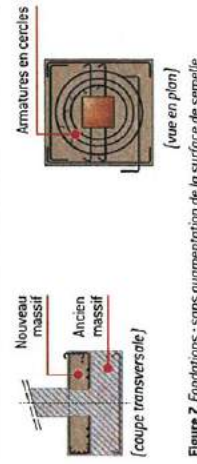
Fondations : sans augmentation de la surface de semelle (vue en plan)
